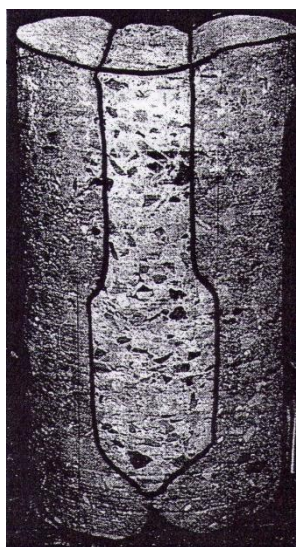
18 – Corte da seção transversal da junta longitudinal entre dois elementos de laje alveolar (FONTE: Boletim 6 FIB, 2000).
